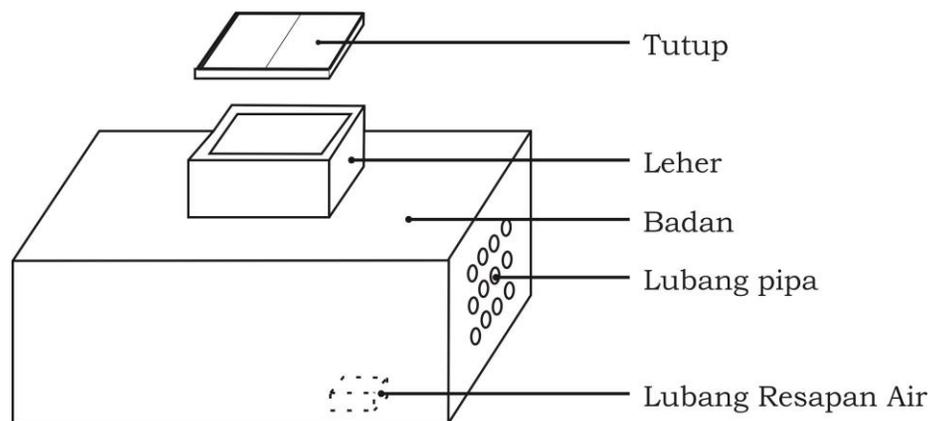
Contoh Ruang Sambung Berdiri Tipe L
